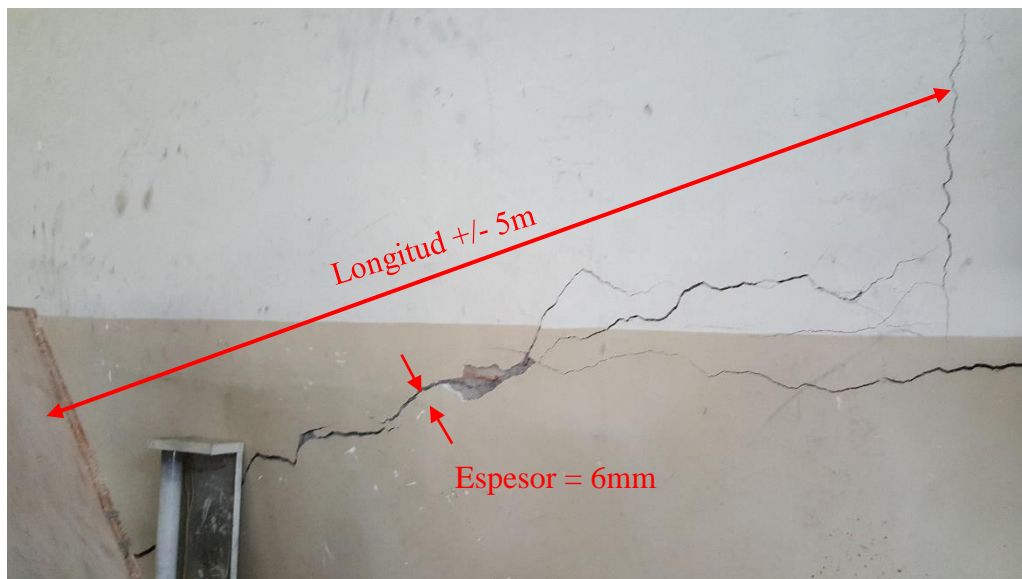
Grieta en mampostería, Planta baja eje 2 y 3 entre C y D, detrás de la grada
